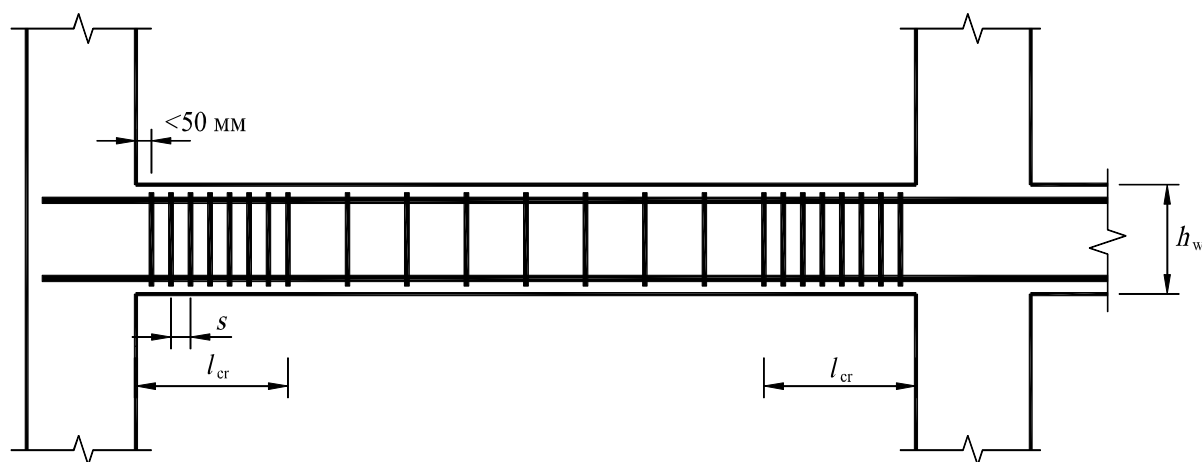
Поперечное армирование в критических зонах балок
